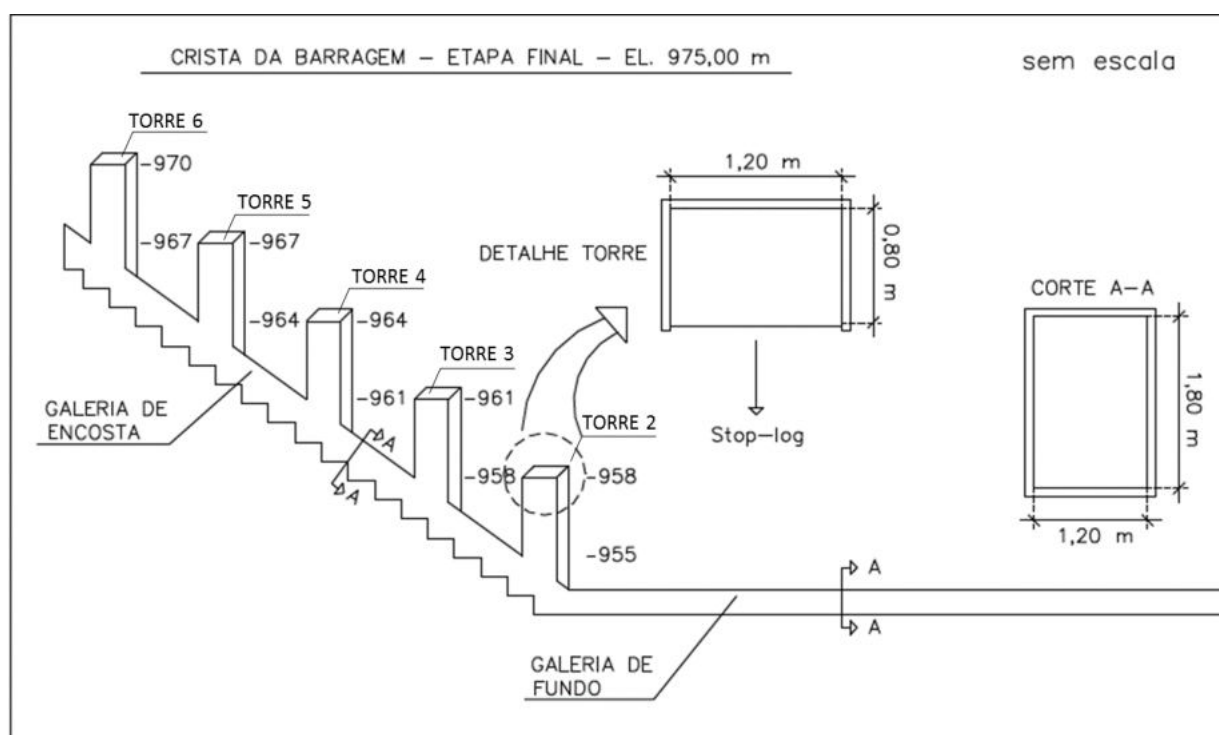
Localização das torres do sistema extravasor da Barragem B5, da galeria de encosta e da galeria de fundo (Fonte: BU-125-MC-18764-00, Pimenta de Ávila, 2010).
